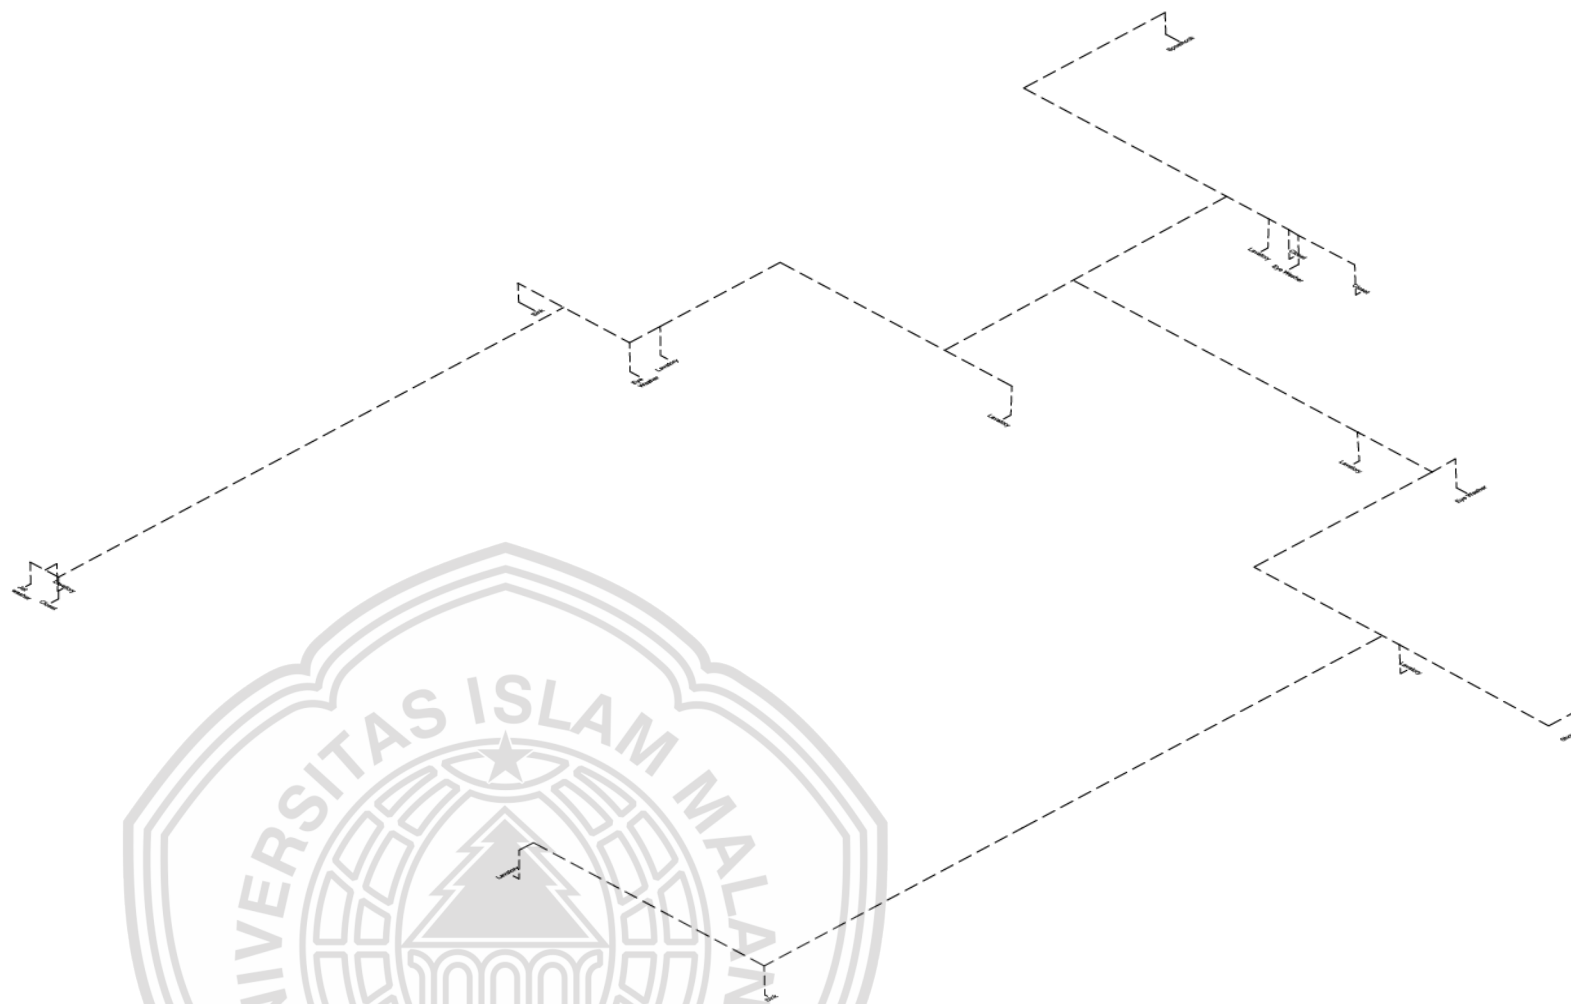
2 Skema Pipa Air Bersih Lantai 1
